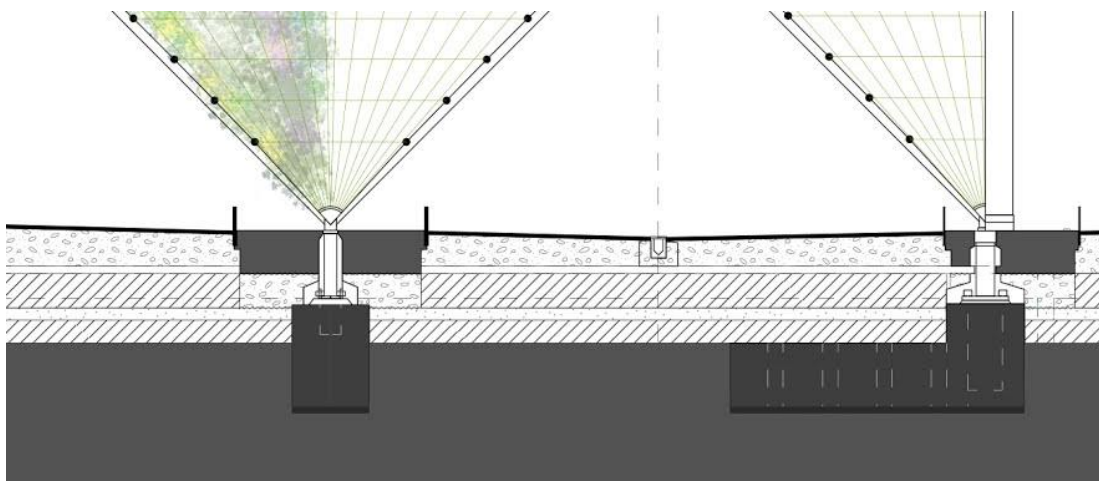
Pormenor de construção da ancoragem da estrutura, Parque MFO, Zurique, Suíça, (<https://urbannext.net/mfo-park/>; acedido a 05/2019)
